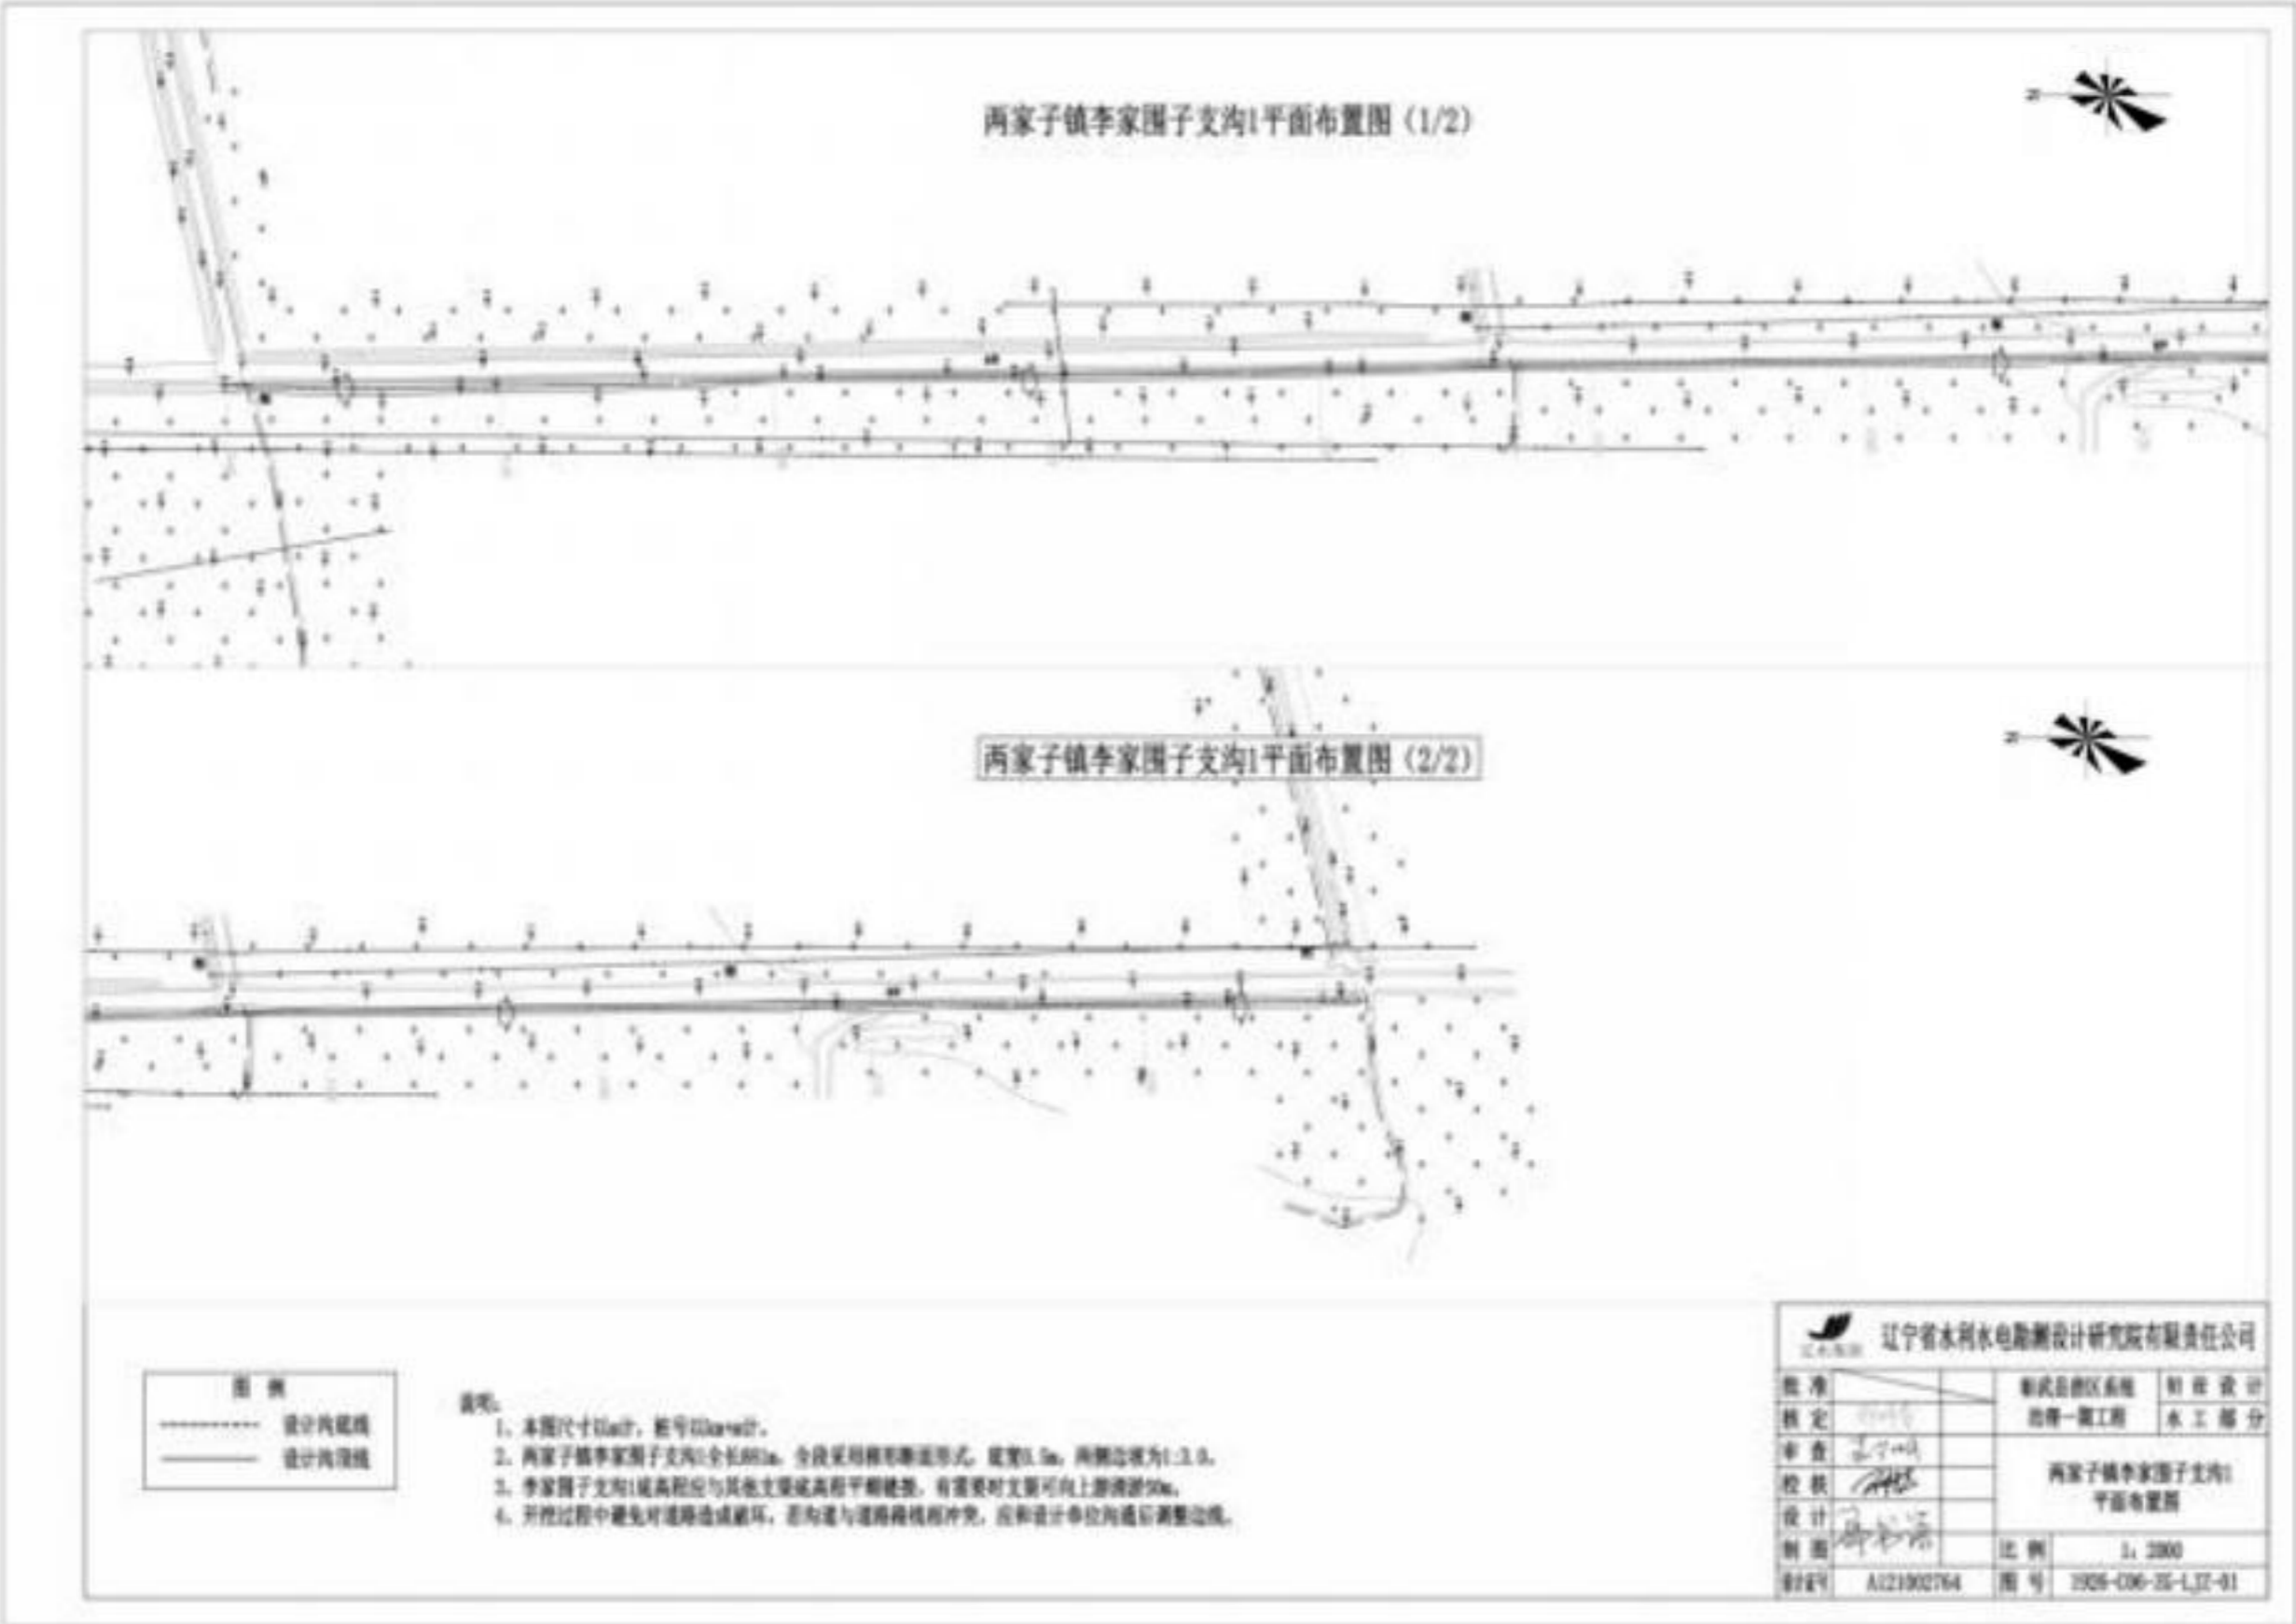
两家子镇李家围支沟 1 平面布置图
